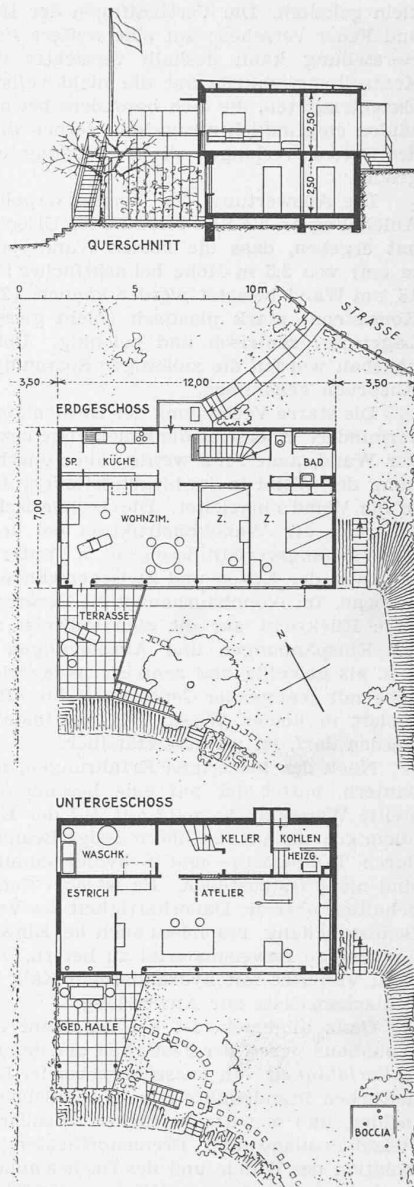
bis 3. Grundrisse und Schnitt. Masstab 1:300.
